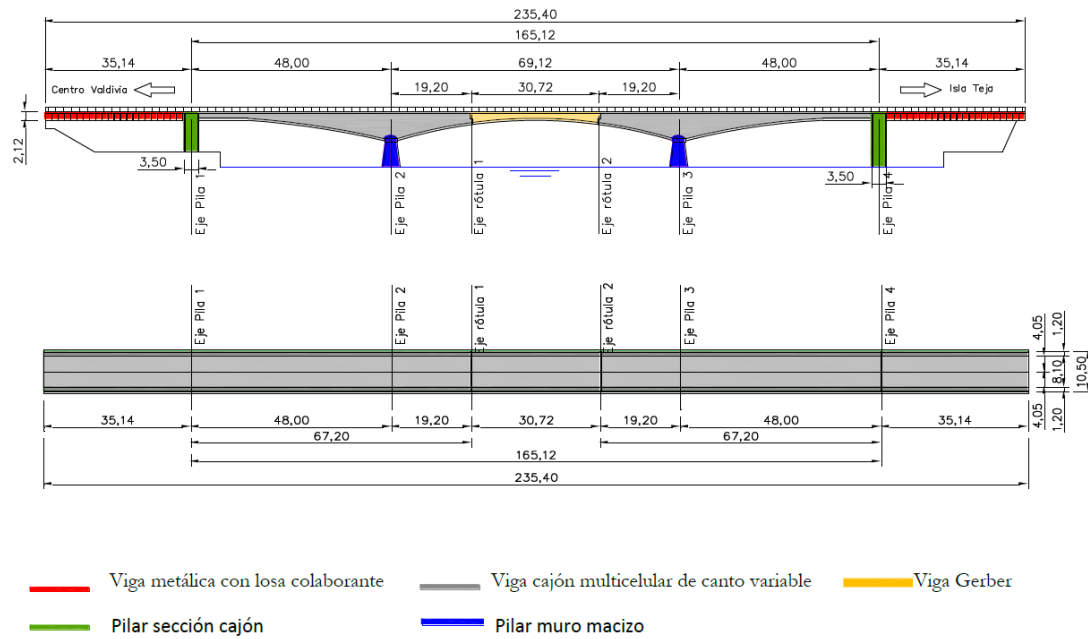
Perfil longitudinal y vista en planta del puente Pedro de Valdivia (metros).
